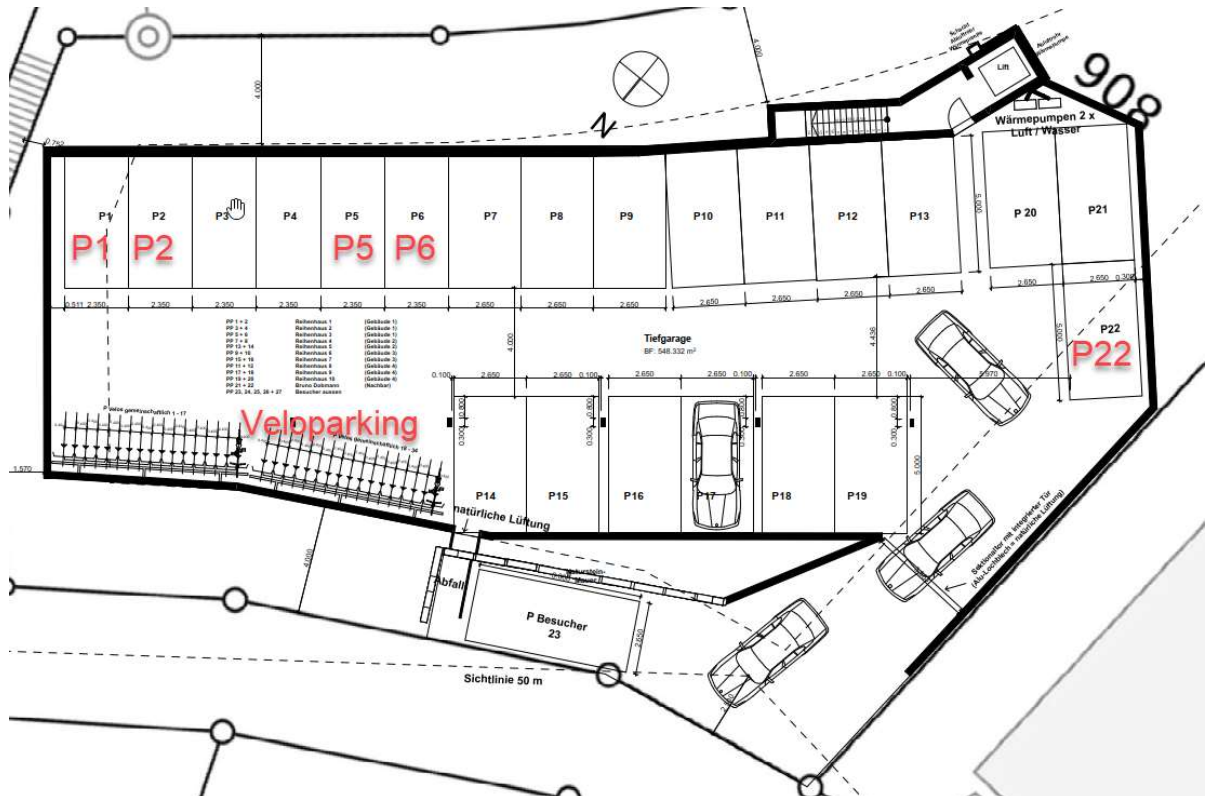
Plan "Grundriss UG"; Beanstandung der Parkfelder 1, 2, 5, 6 und 22 sowie des Veloparkings
